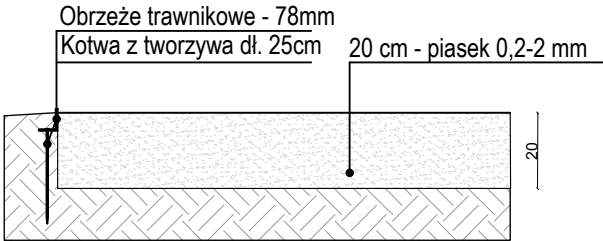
Projektowana nawierzchnia – konstrukcja
